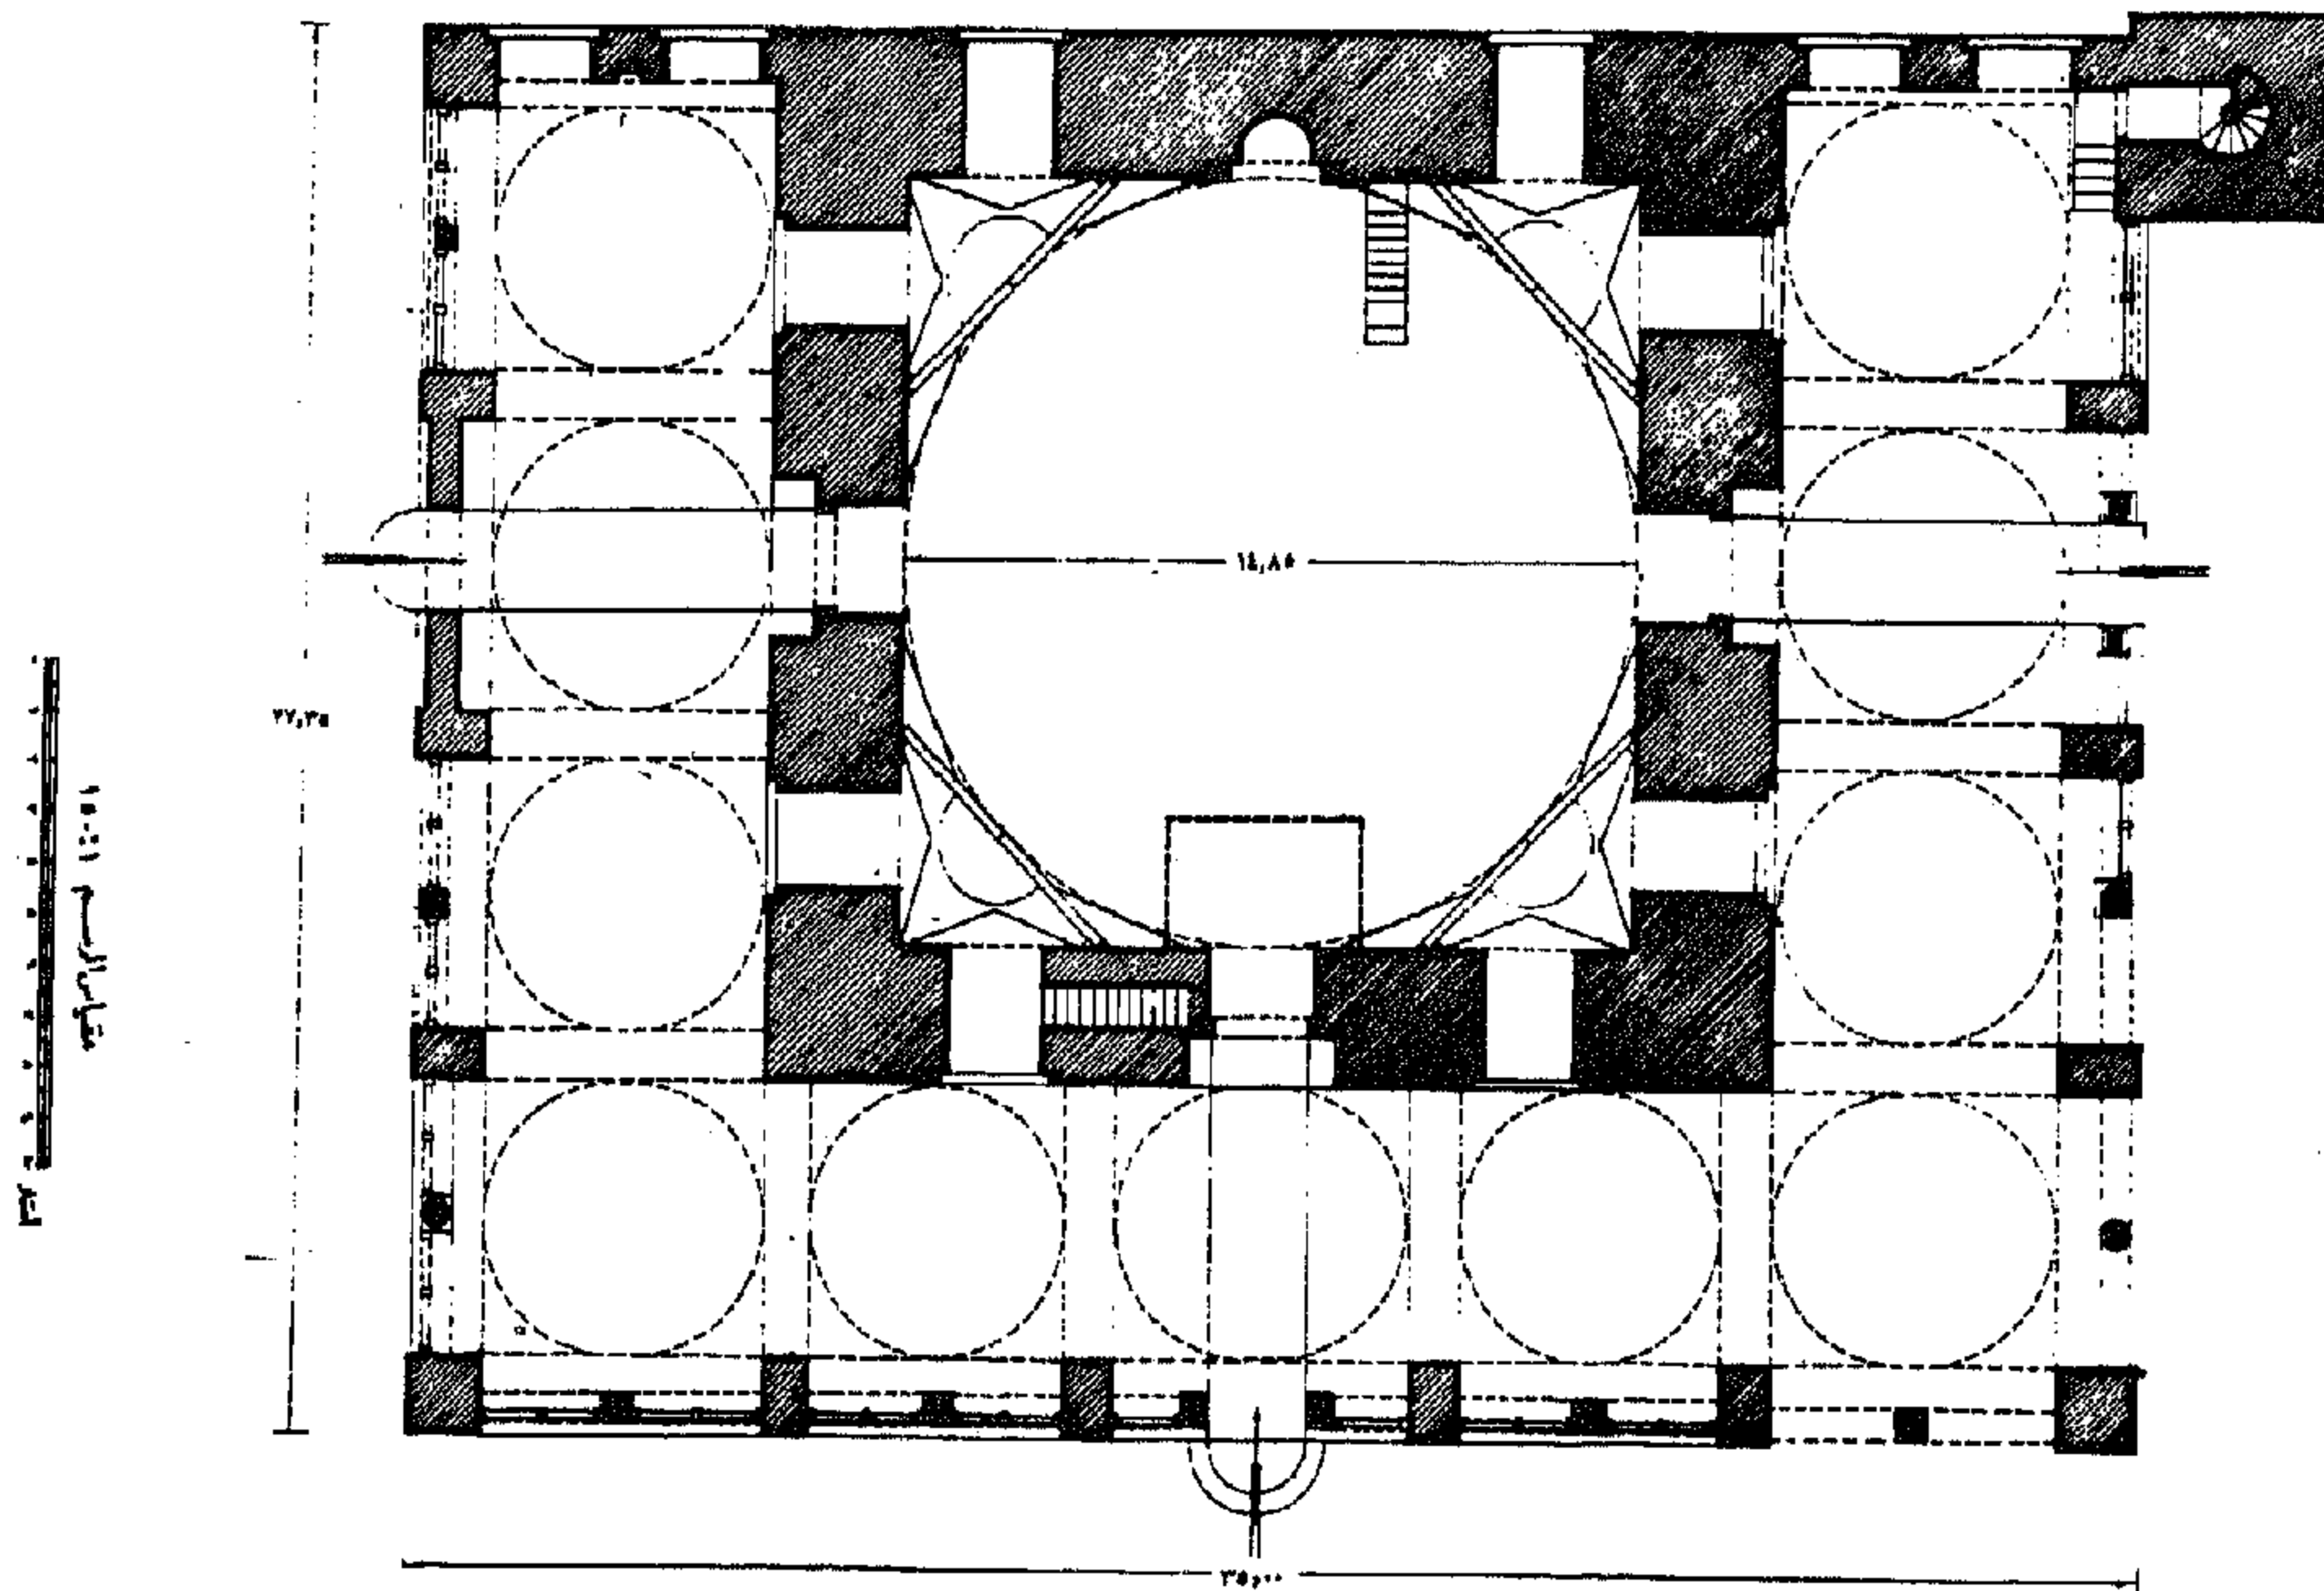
مسقط أفقي لمدرسة جوك بسيفاس
